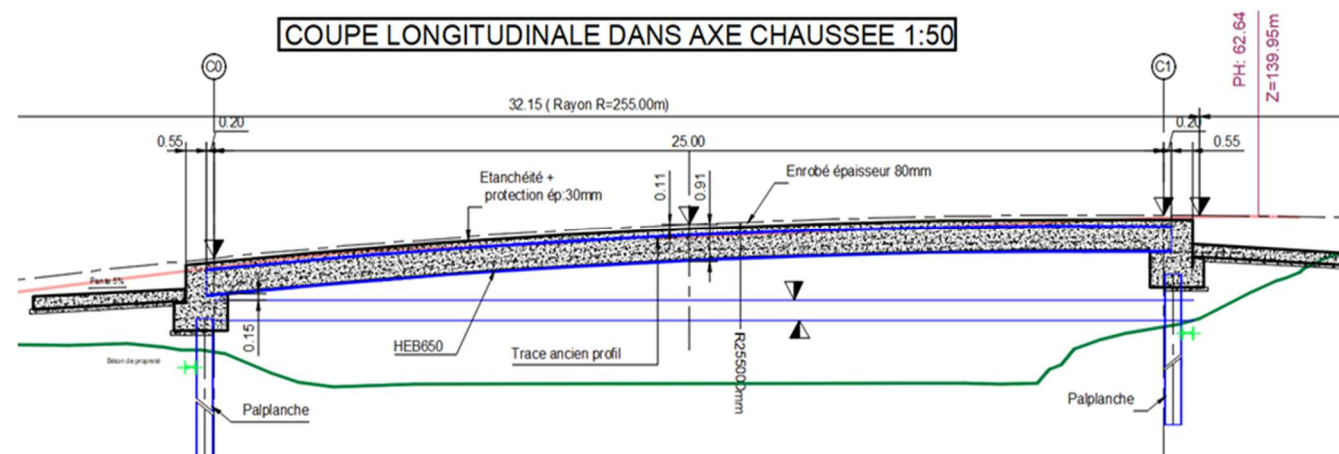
Coupe du futur ouvrage Eglise Rouge
